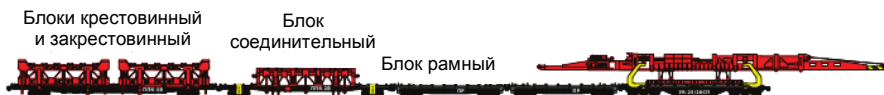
Состав для перевозки стрелочного перевода блоками и укладки его краном УК-25СП
